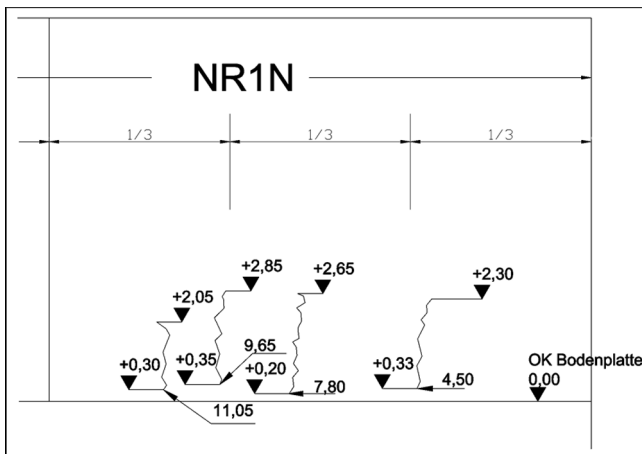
Risskartierung eines Wandbetonierabschnittes am Stever-Durchlass
